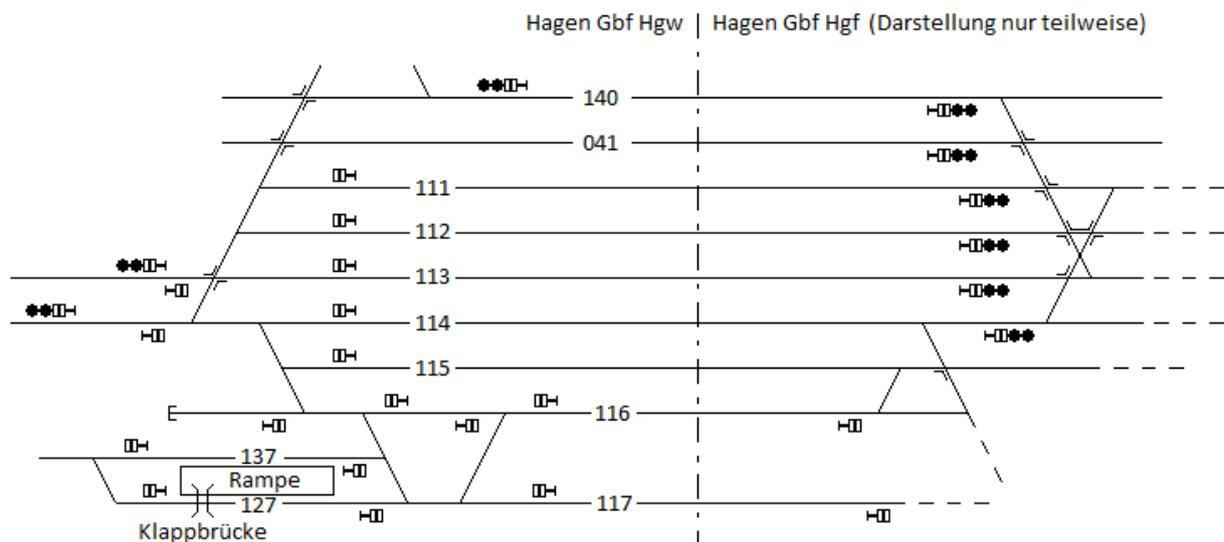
Rampe / Anpassung Hagen Gbf Hgf
